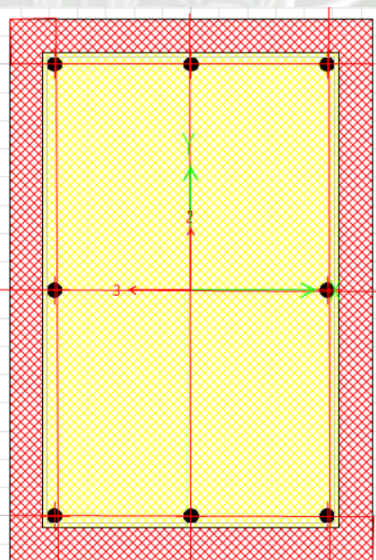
Sección de columnas y vigas de 0.40x0.60m, 8 varillas de 5/8" Estribos de 3/8"
